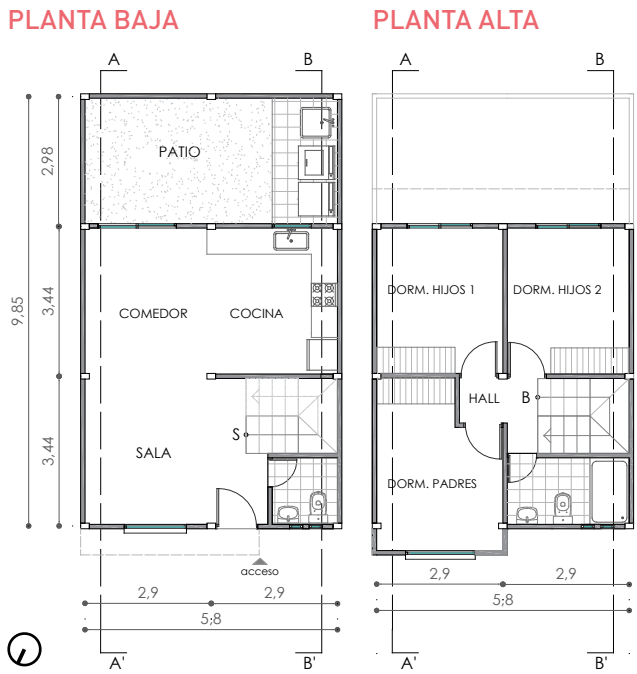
Plantas arquitectónicas vivienda esquinera sureste
